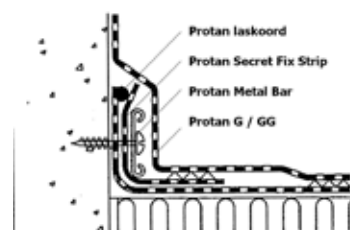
Fixation au droit de l'angle du relevé au moyen de Secret Fix Strip
